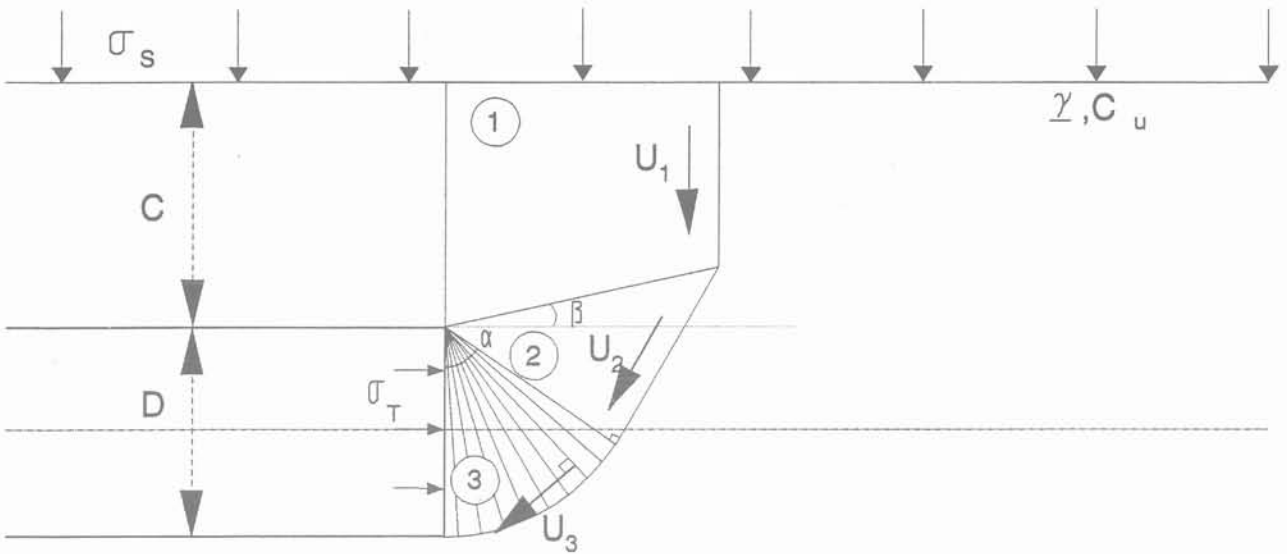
Mécanisme M02. - Fig. 3. — Failure mechanism M02.
